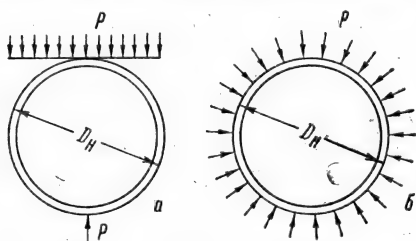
Схемы работы газопроводов в грунте под воздействием внешних нагрузок.
